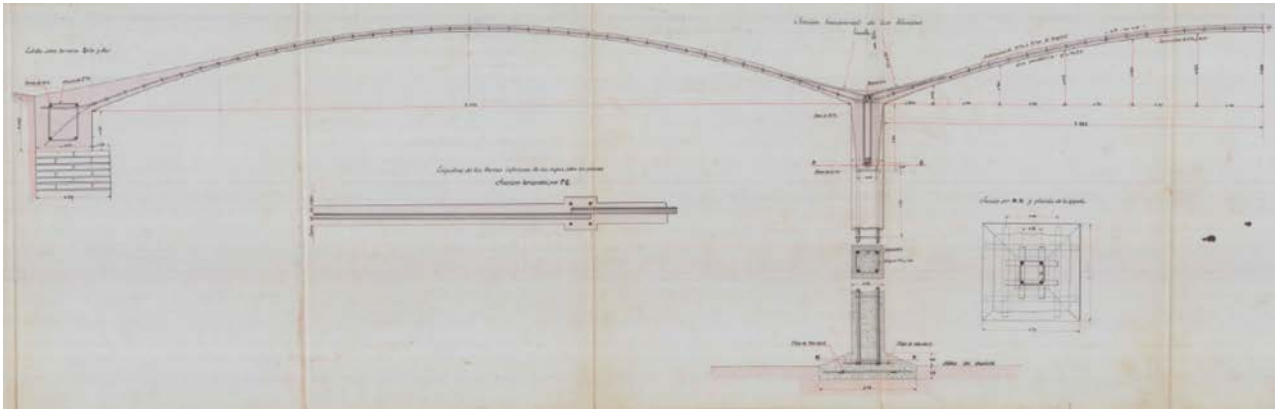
Sección transversal de la cubierta propuesta por Ribera.
